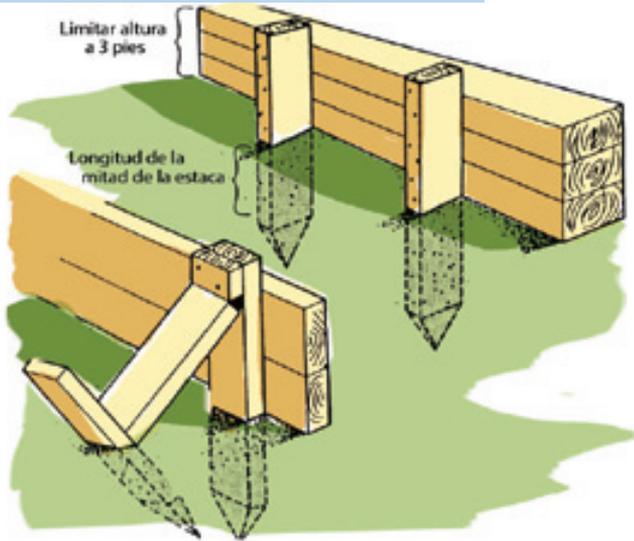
Típica instalación de madera - Maderas requieren un anclaje sólido para proveer estabilidad.
